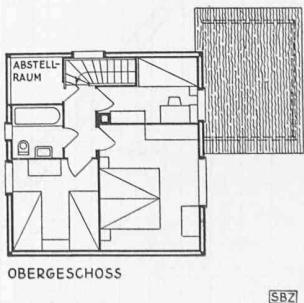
Grundrisse zu Bild 1, Maßstab 1 : 250
